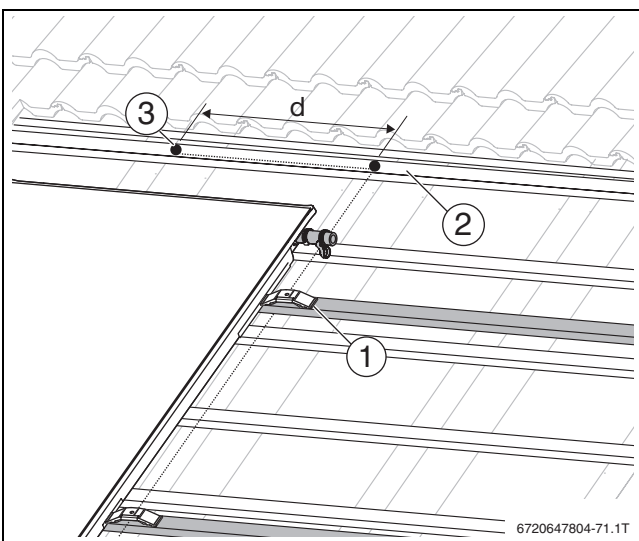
Posición de montaje del conector superior en colectores horizontales
